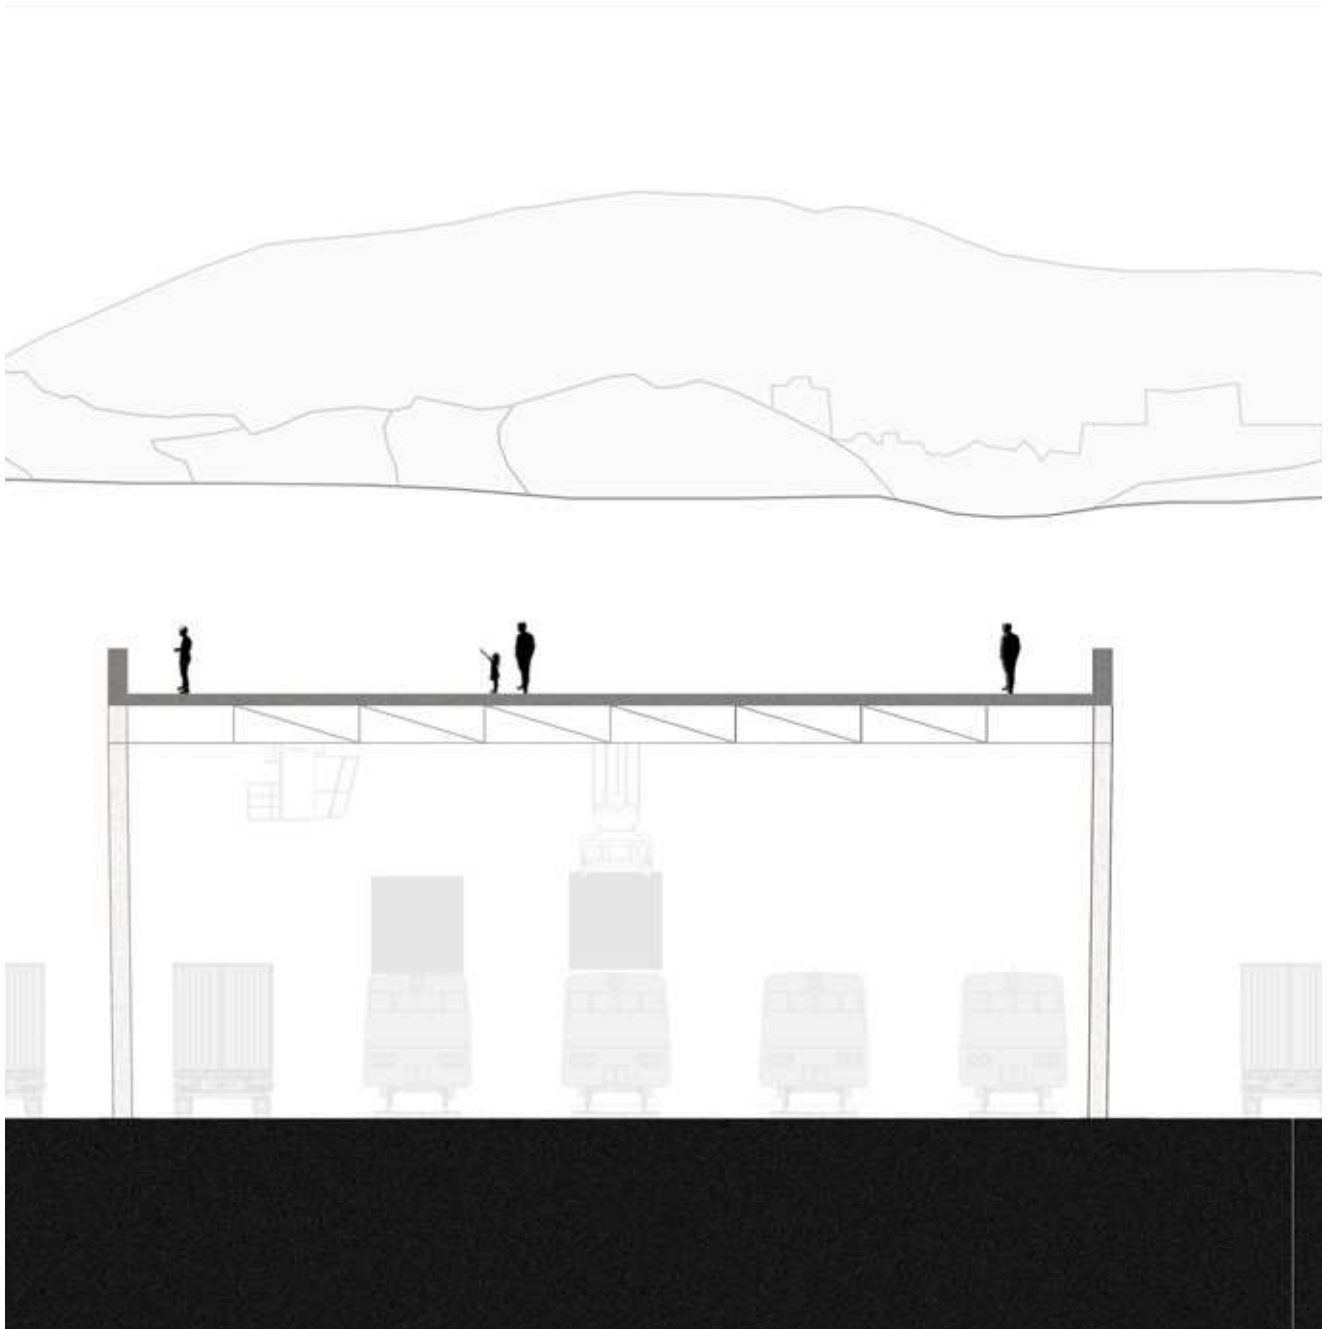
COLAGEM DA PROPOSTA ELABORADA PARA A ZONA DE TERMINAL DE CARGA
